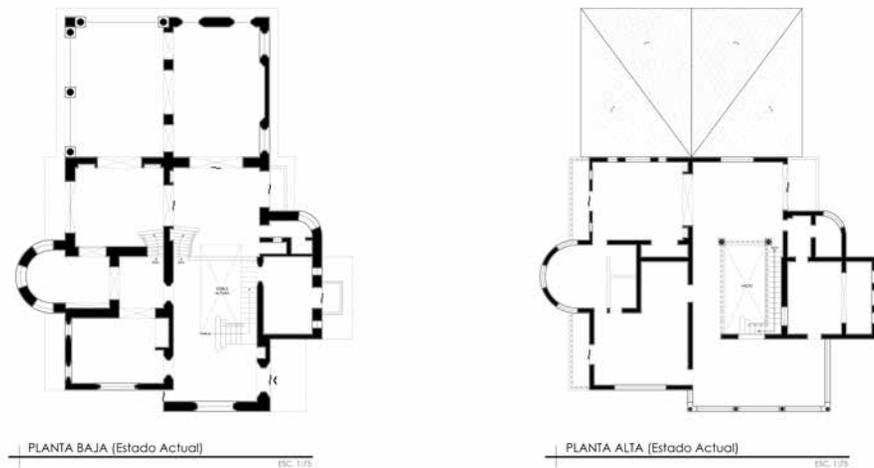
Plantas arquitectónicas de la Quinta Tzipécula.
